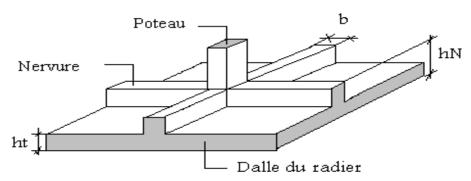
Disposition des nervures par rapport au radier et aux poteaux VII.5.1 Pré dimensionnement de radier :
